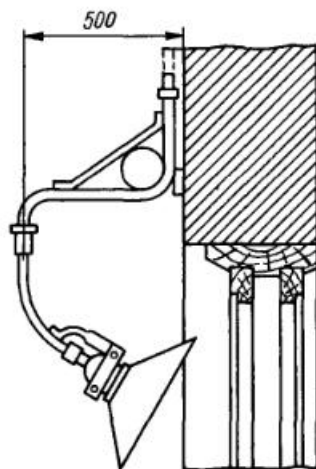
Освещение помещения светильником, установленным снаружи здания перед оконным проемом
